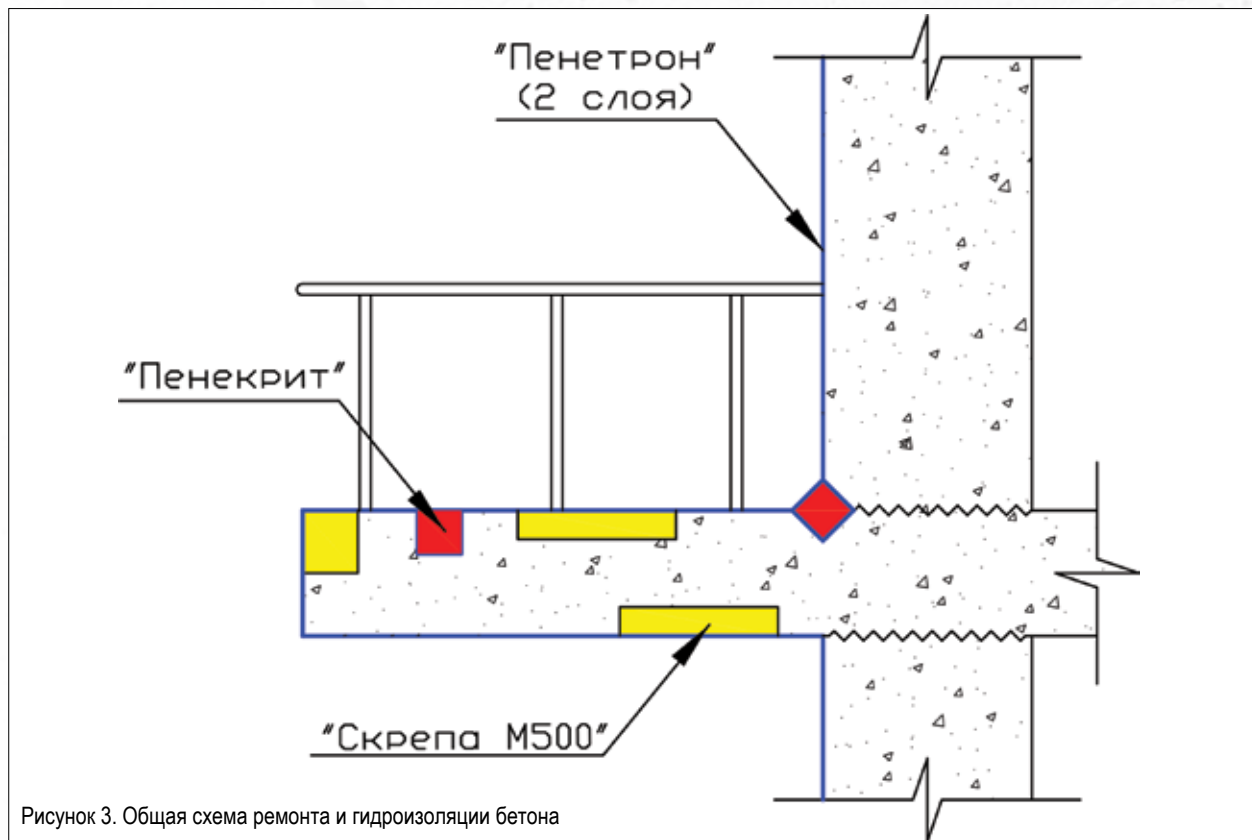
Общая схема ремонта и гидроизоляции бетона
